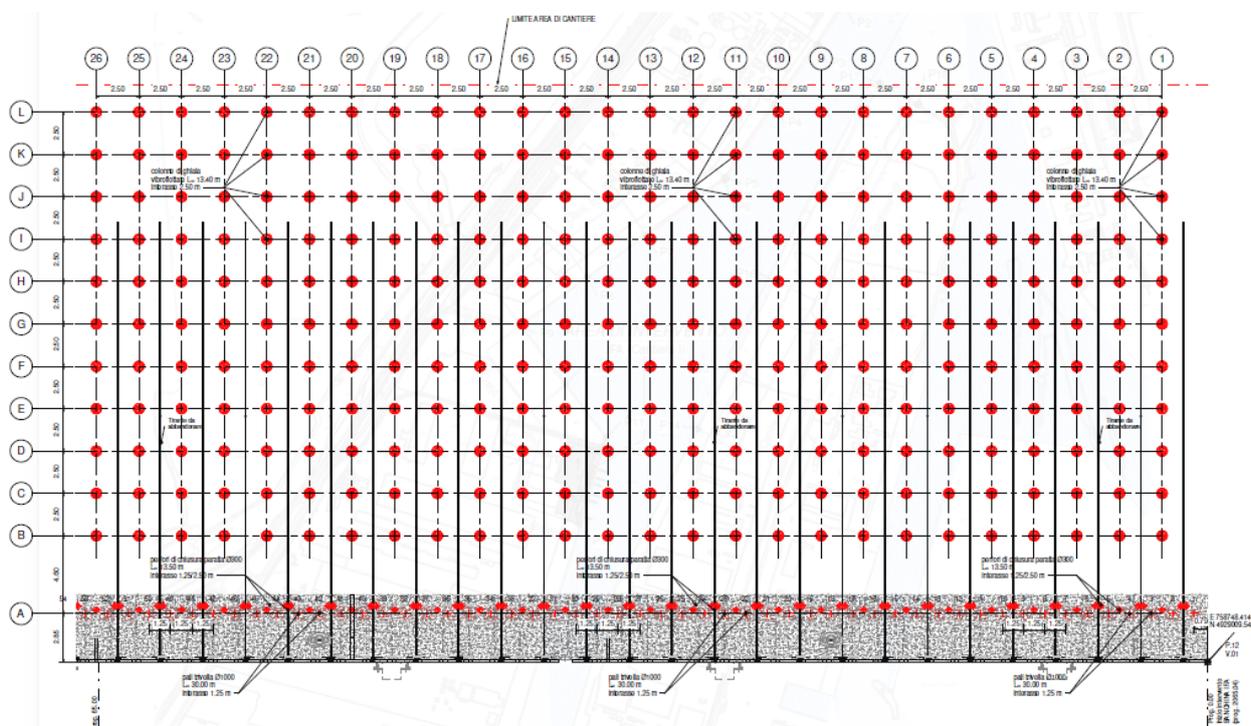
Stralcio planimetrico tracciamento colonne di ghiaia
